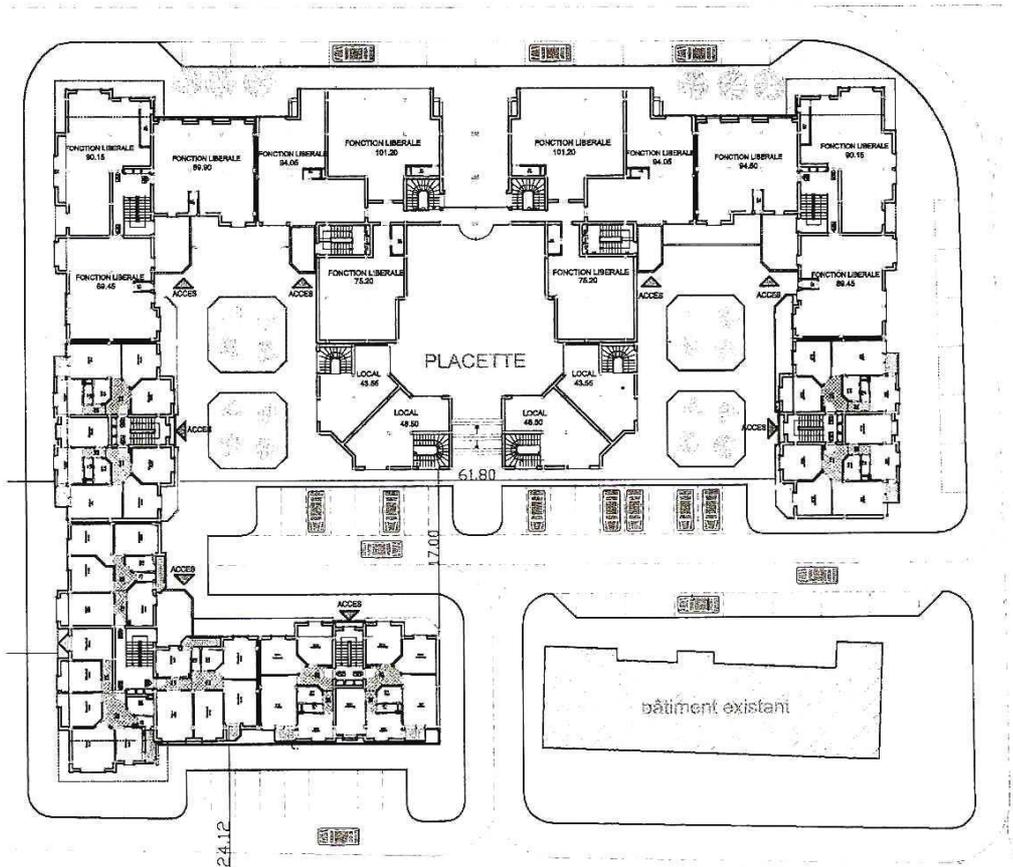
Plan du premier étage des immeubles des immeubles LSP - échelle : 1/800
